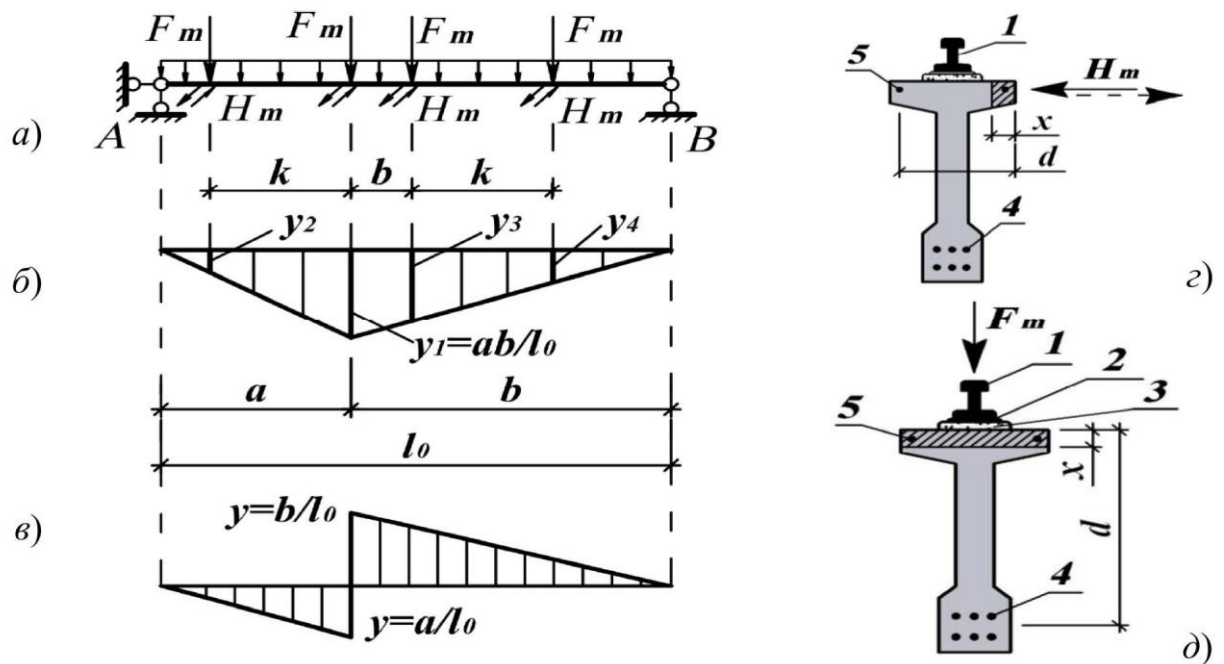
Розрахункові схеми до проектування підкранових балок: а – схема завантаження; б – лінія впливу M ; в – лінія впливу V ; г – розрахункова схема поперечного перерізу на дію вертикальних навантажень; д – розрахункова схема поперечного перерізу на дію горизонтальних навантажень;
